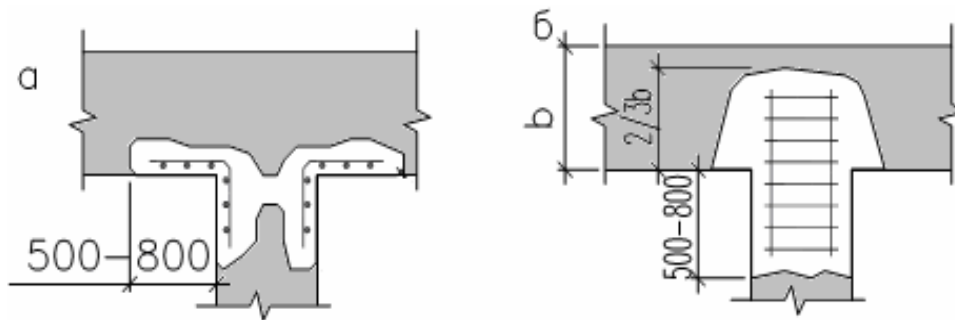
Восстановление сопряжений железобетонными шпонками: *а* – с вертикальными арматурными каркасами, *б* – то же, с горизонтальными каркасами
